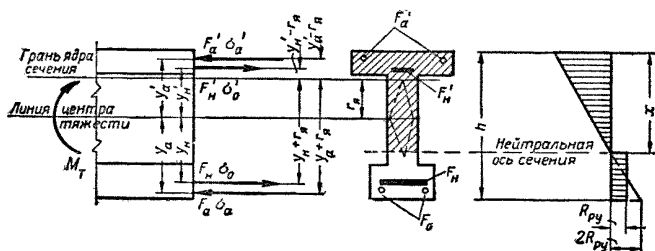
Схема распределения напряжений и усилий предварительно напряженного железобетонного изгибаемого элемента при расчете трещиностойкости зоны, содержащей арматуру F_n и F_a
